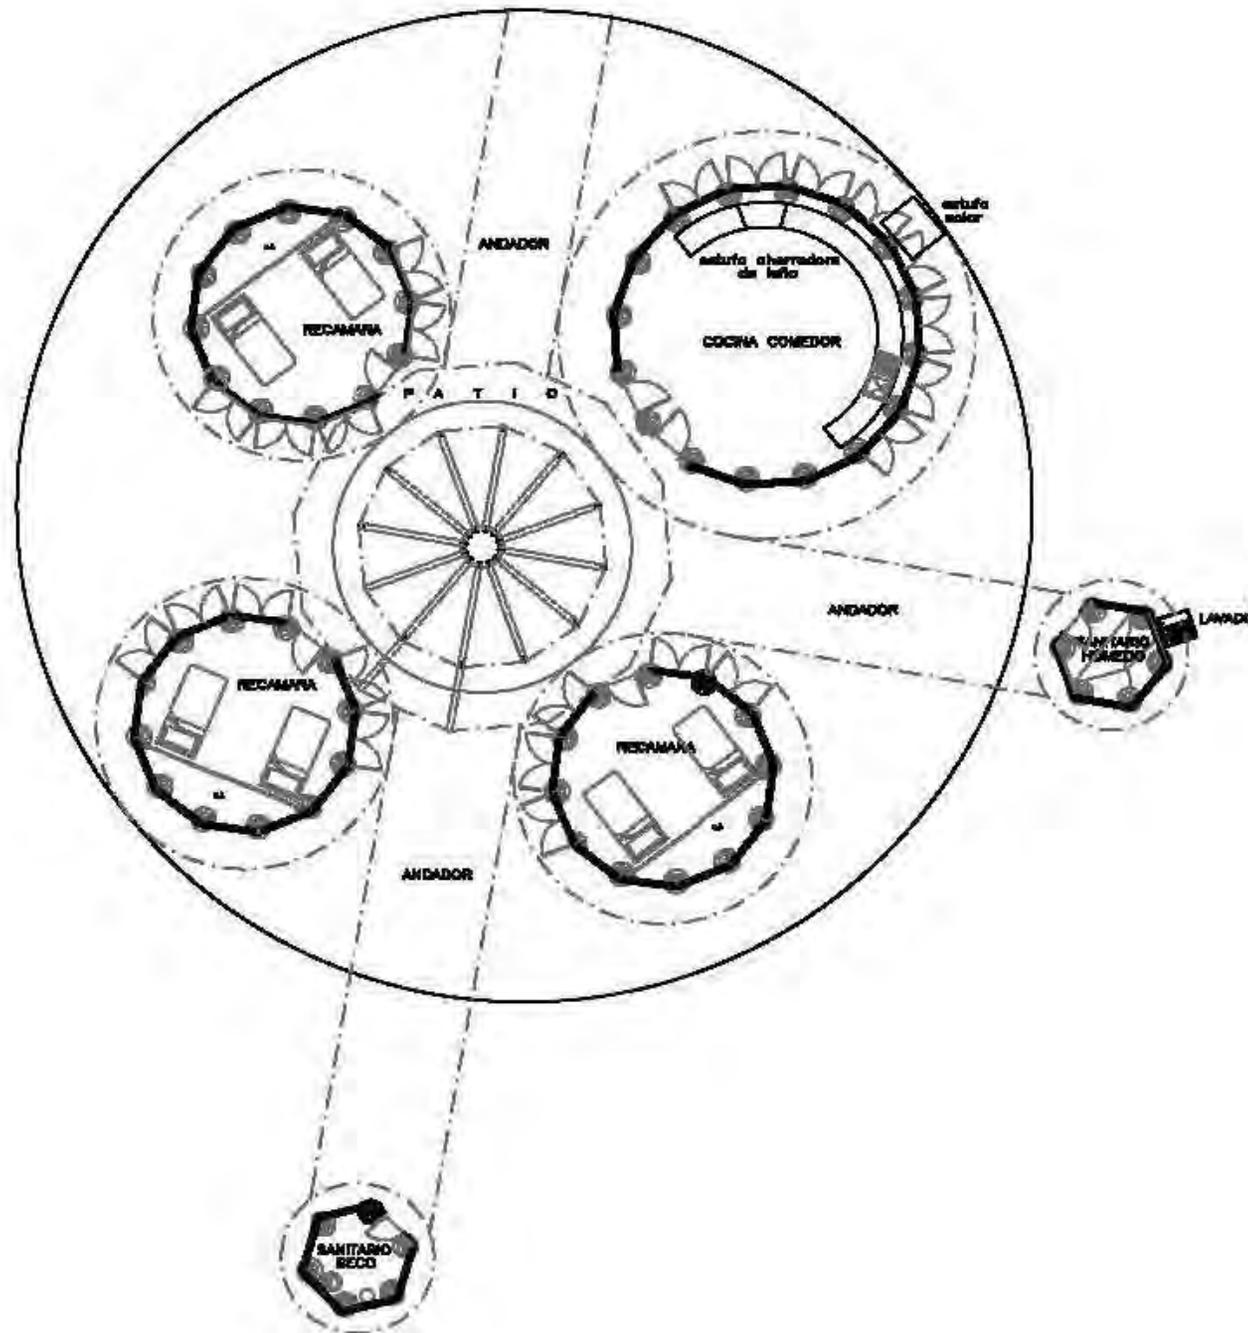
, planos generales en donde se observan la planta general, y planta de techos del Prototipo de Vivienda
